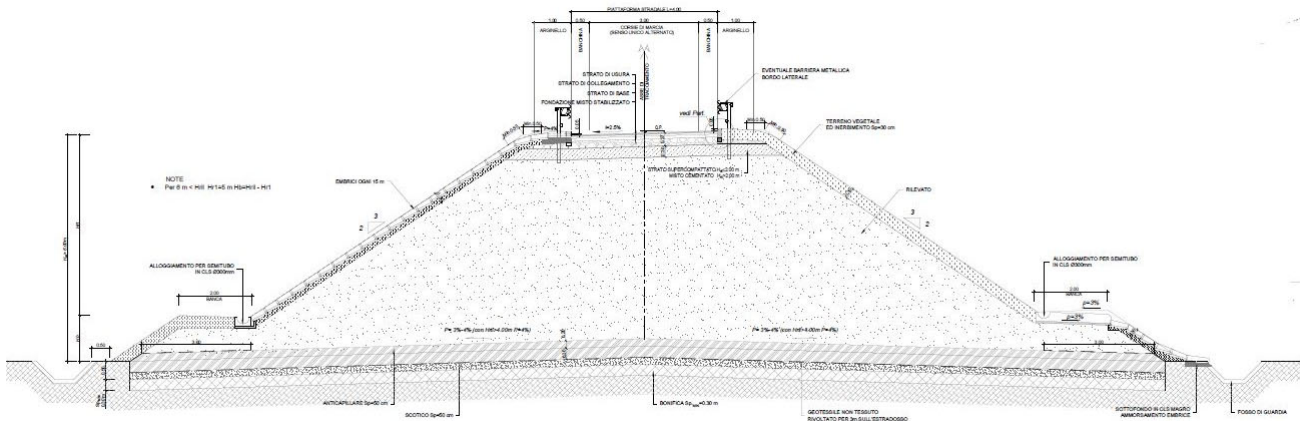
Dest. Particolare 4.0 m - sezione tipo in rilevato Hril > 6.00 m
